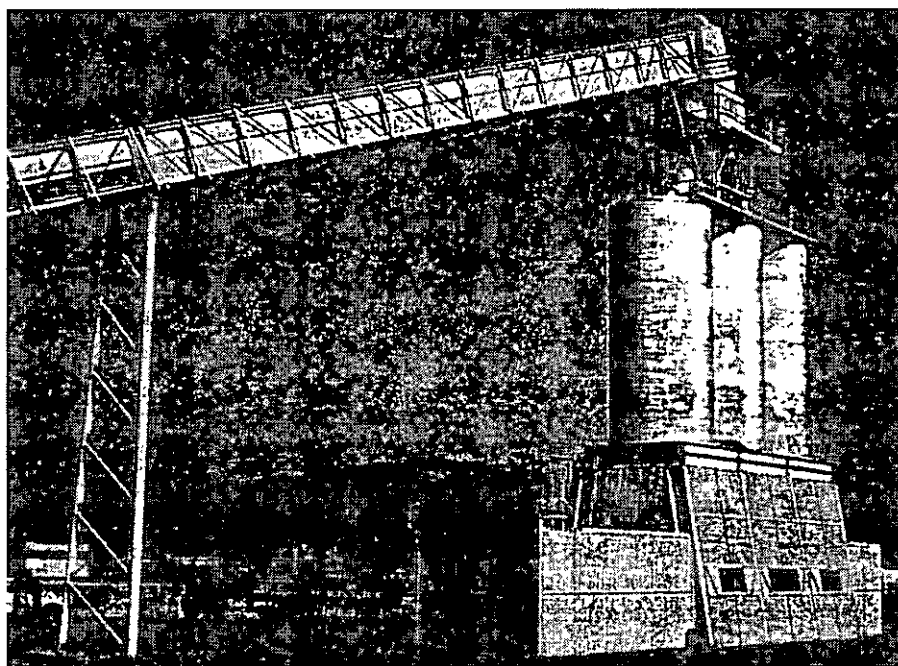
Silos Aislados de Almacenaje de Alta Capacidad para Concreto Asfáltico.
